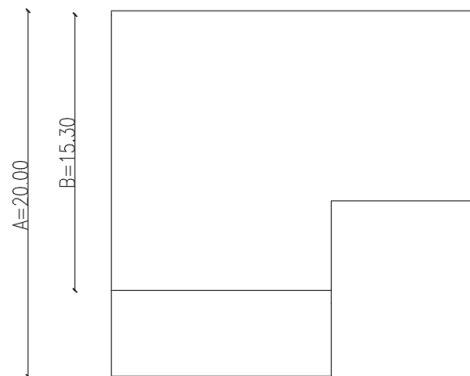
Forma irregular en plantas primeras con plantas superiores. Elaboración Propia (2025).
